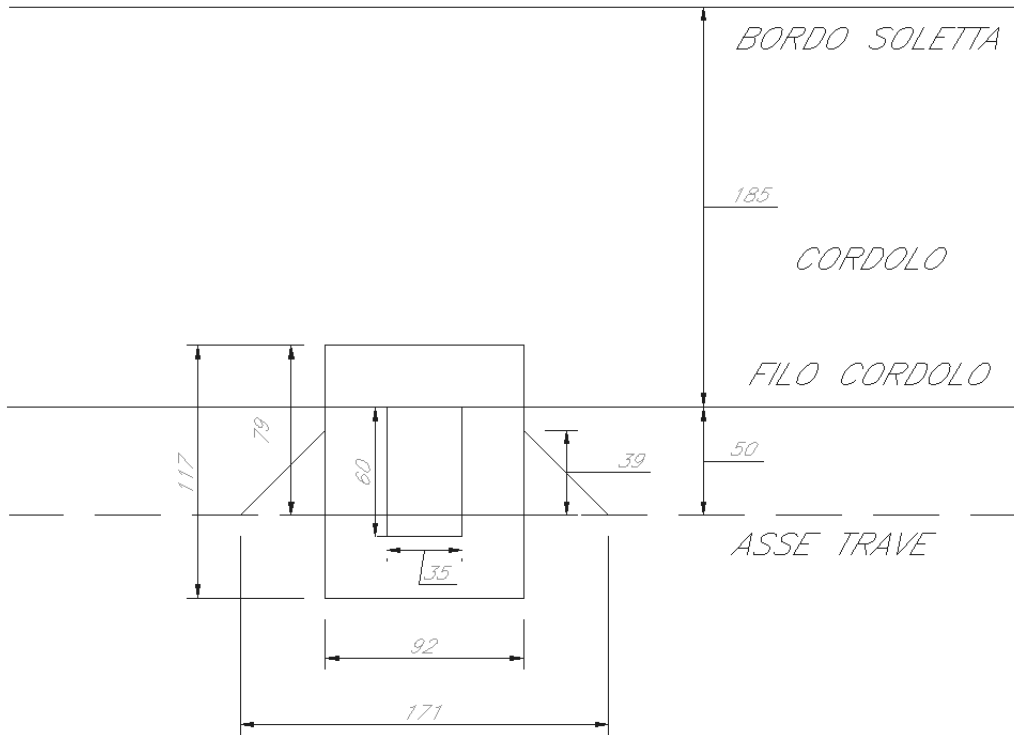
Stralcio planimetrico con diffusione dei carichi
